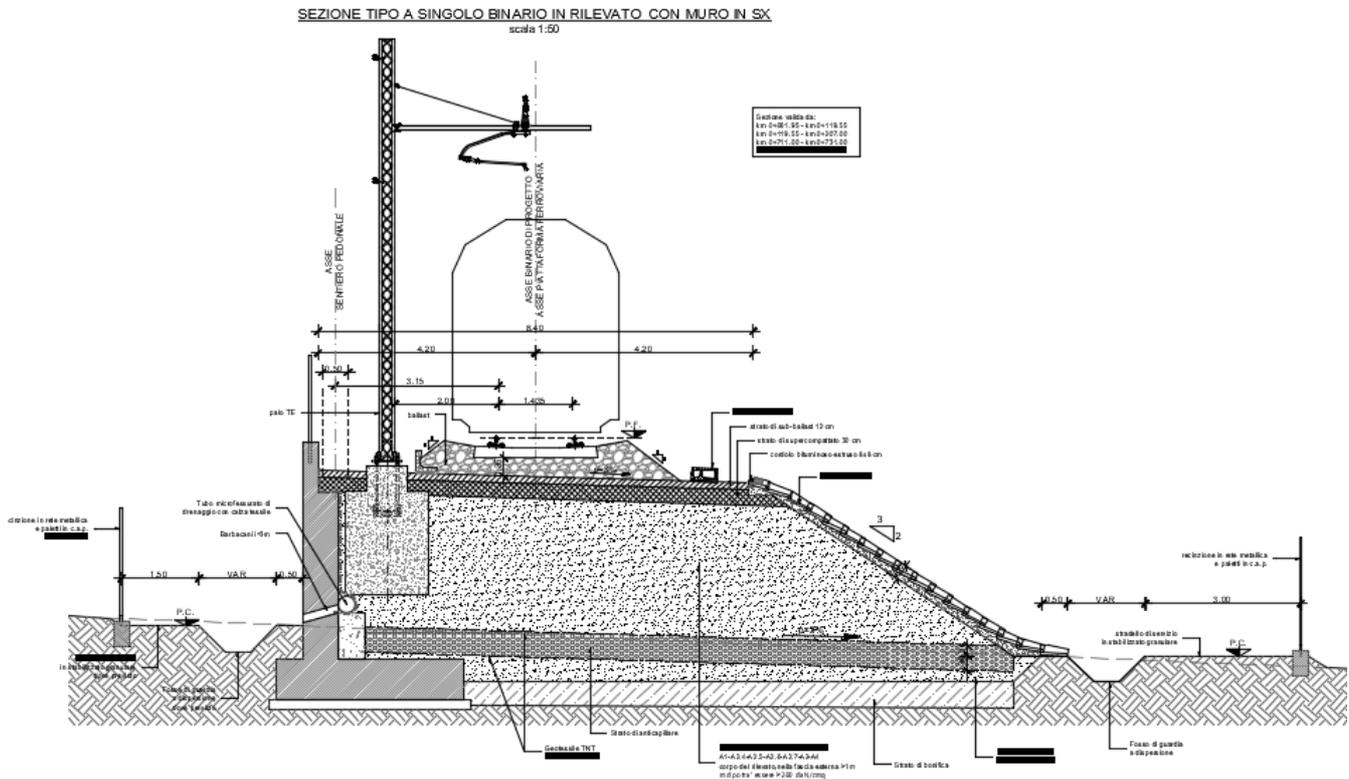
Sezione tipo SB in rilevato con muro in sinistra - asta L=750m
